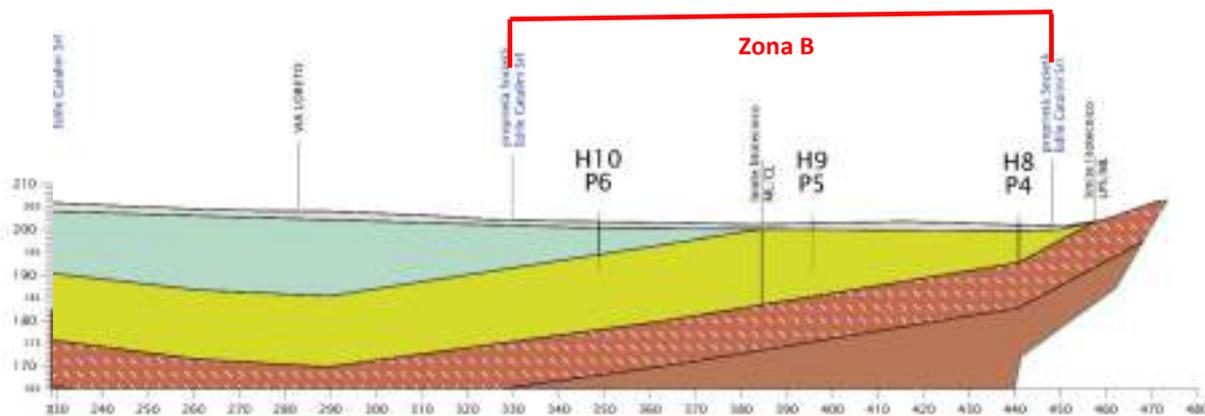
ubicazione ZONA B su STRALCIO SEZIONE LITOTECNICA A-A: da Ovest Nord Ovest in direzione di Est Sud Est
